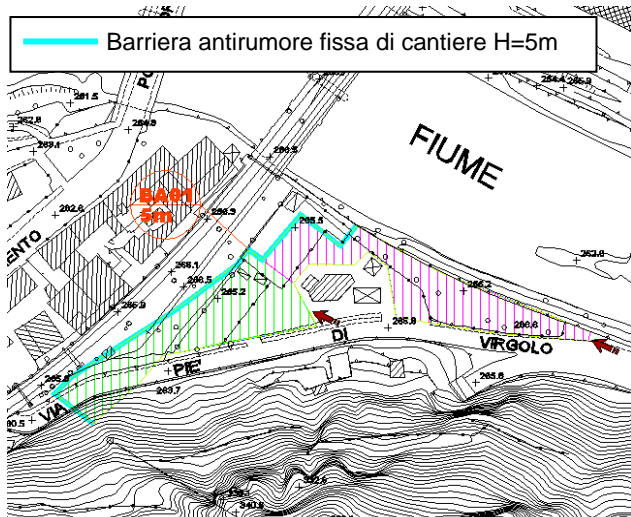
Localizzazione della barriera antirumore di cantiere BA01
